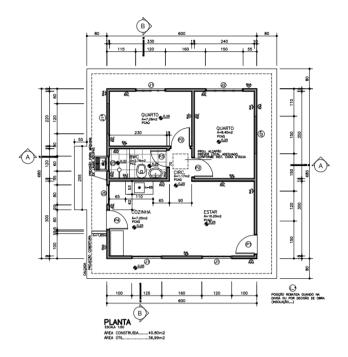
Planta baixa, projeto em estudo, CF 40 G1. Fonte: Companhia de Habitação do Paraná (COHAPAR)
